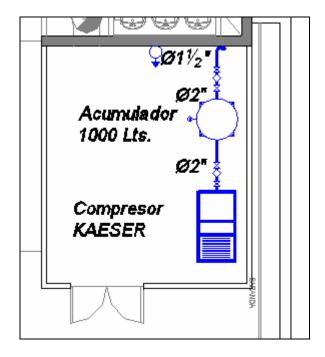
PLANTA SALA DE COMPRESOR.
